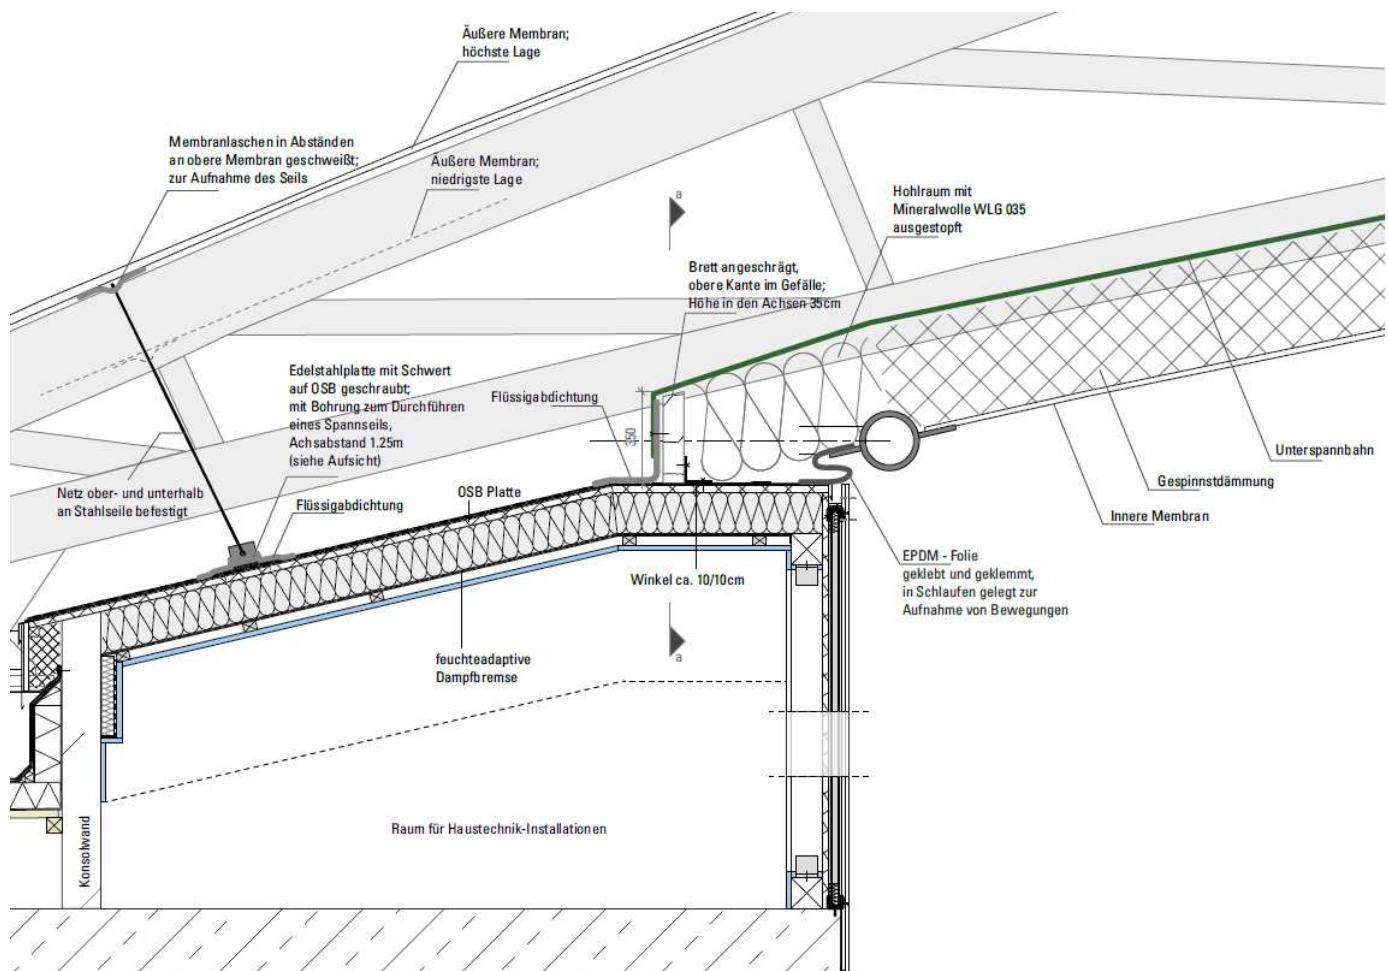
Querschnitt des Dachaufbaus mit Drahtnetz als Halterung der Wärmedämmschicht (grün)
